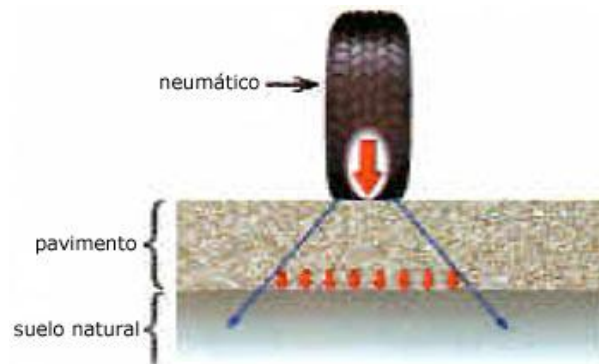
ESTRUCTURACION DEL PAVIMENTO
